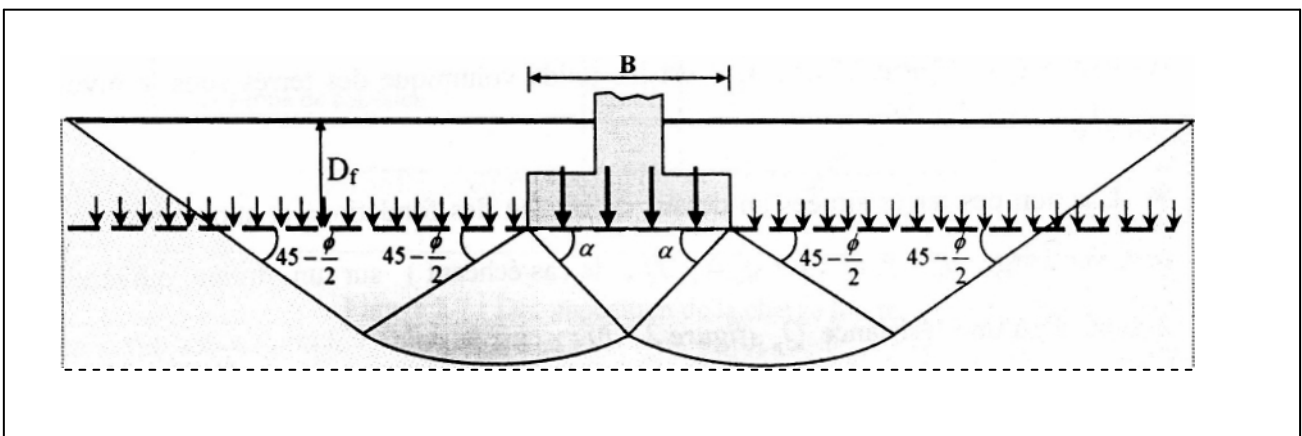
Mécanisme de rupture d'une fondation de base rugueuse (Terzaghi (1943)).
